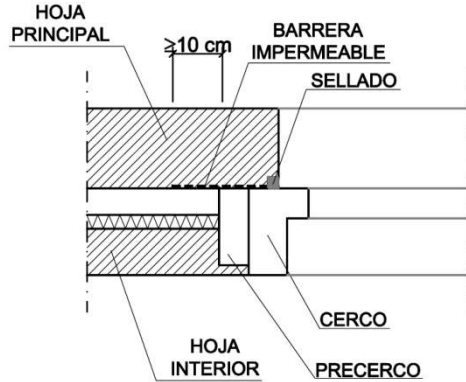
Ejemplo de encuentro de la fachada con la carpintería
